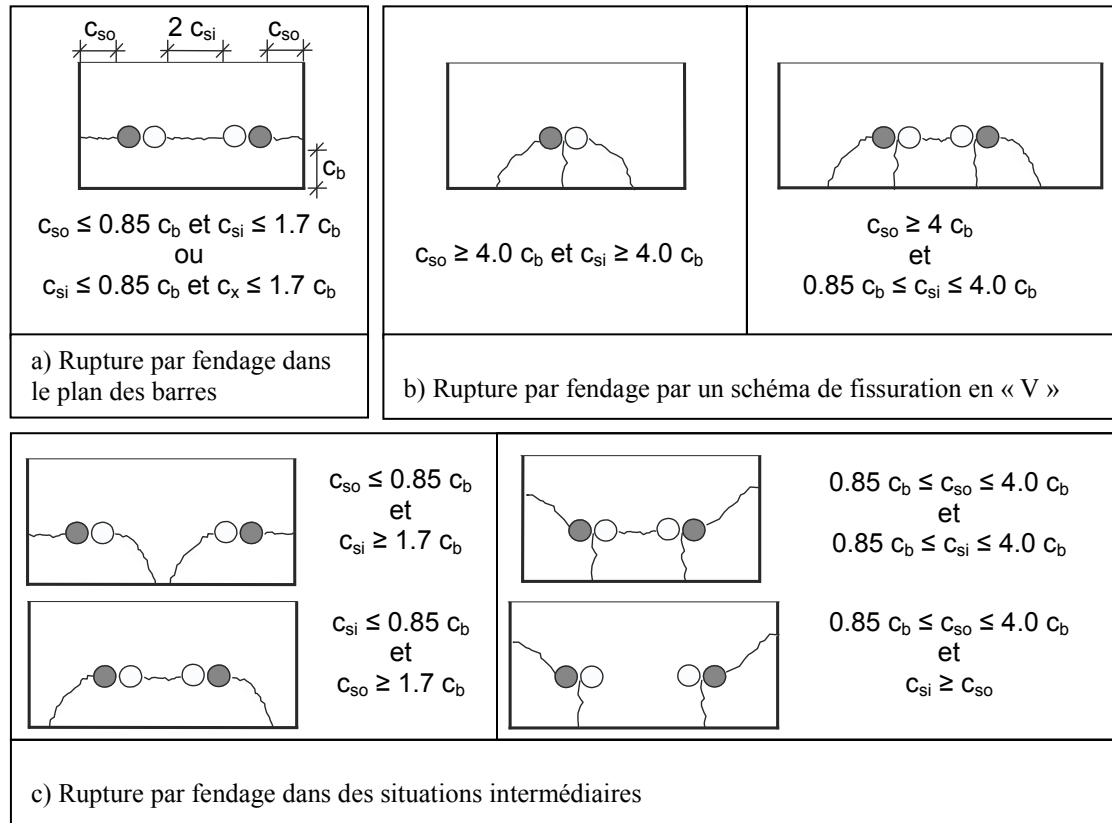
Orientation de la fissuration de fendage, adapté de Eligehausen (1979)
